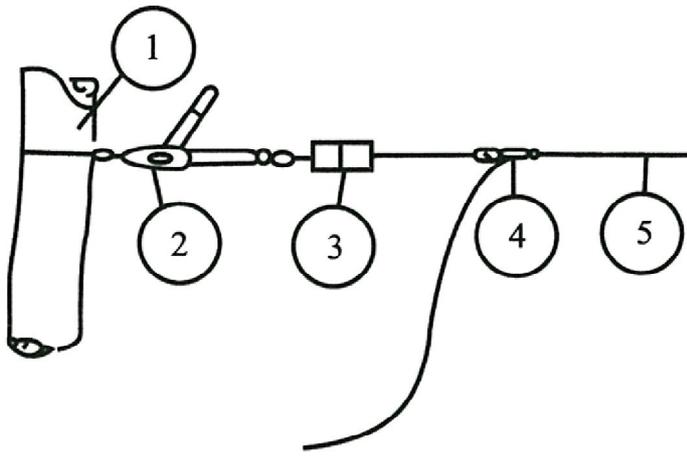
Закрепление монтажного ролика и лебедки на проводе
